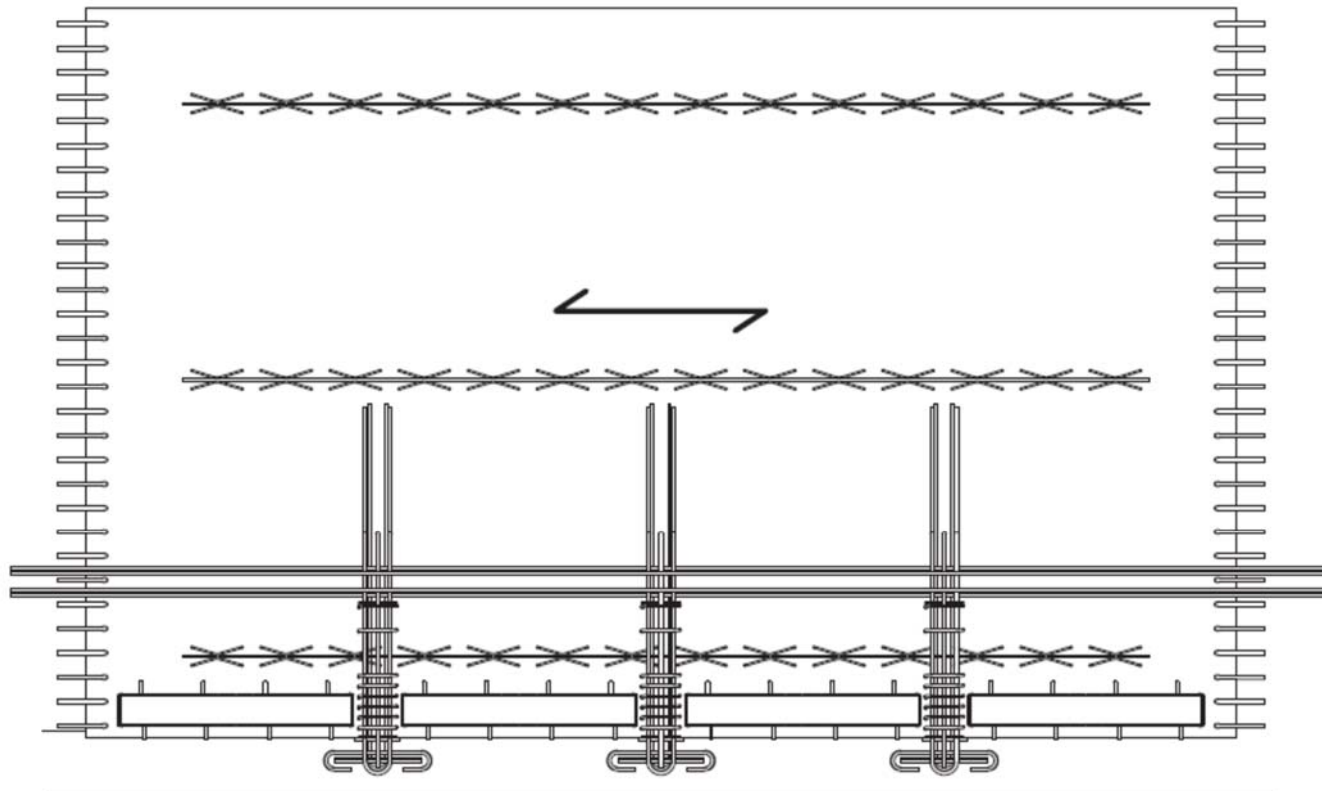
Cas de la prédalle d'about - Vue en plan – Coffrage -
